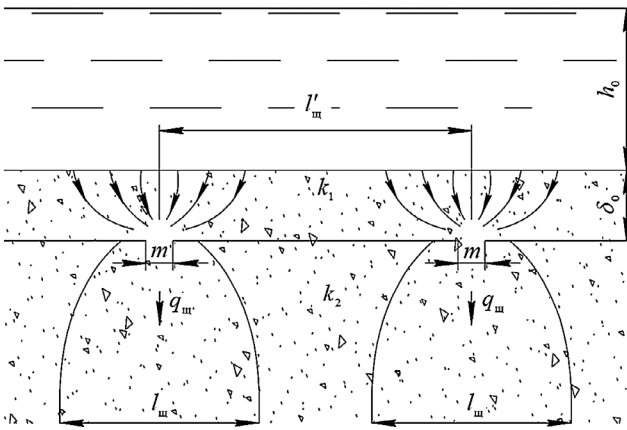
Расчетная схема фильтрации через грунтопленочный экран:
